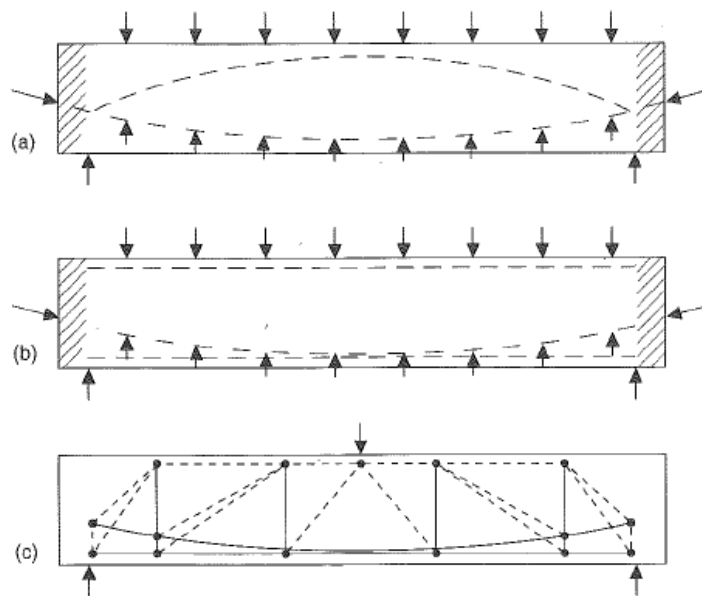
Modelos para vigas pretensadas
